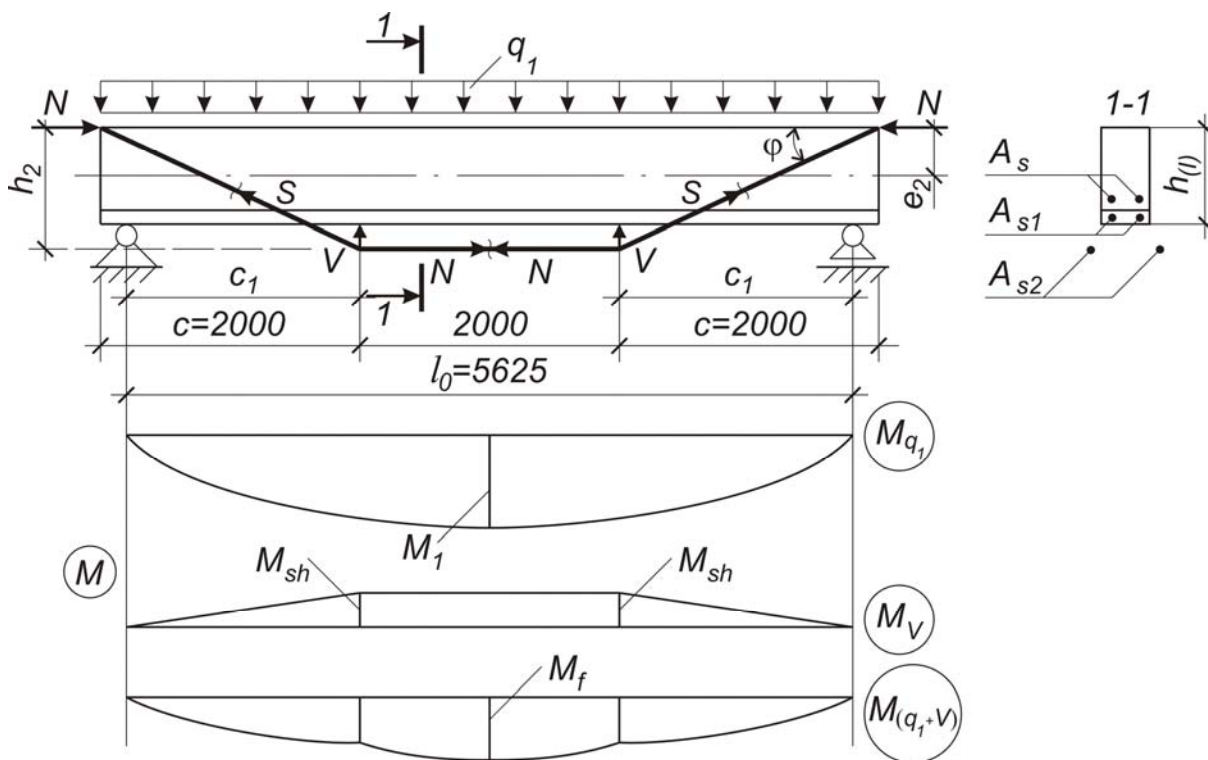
Расчетная схема ригеля после усиления шпренгелем
